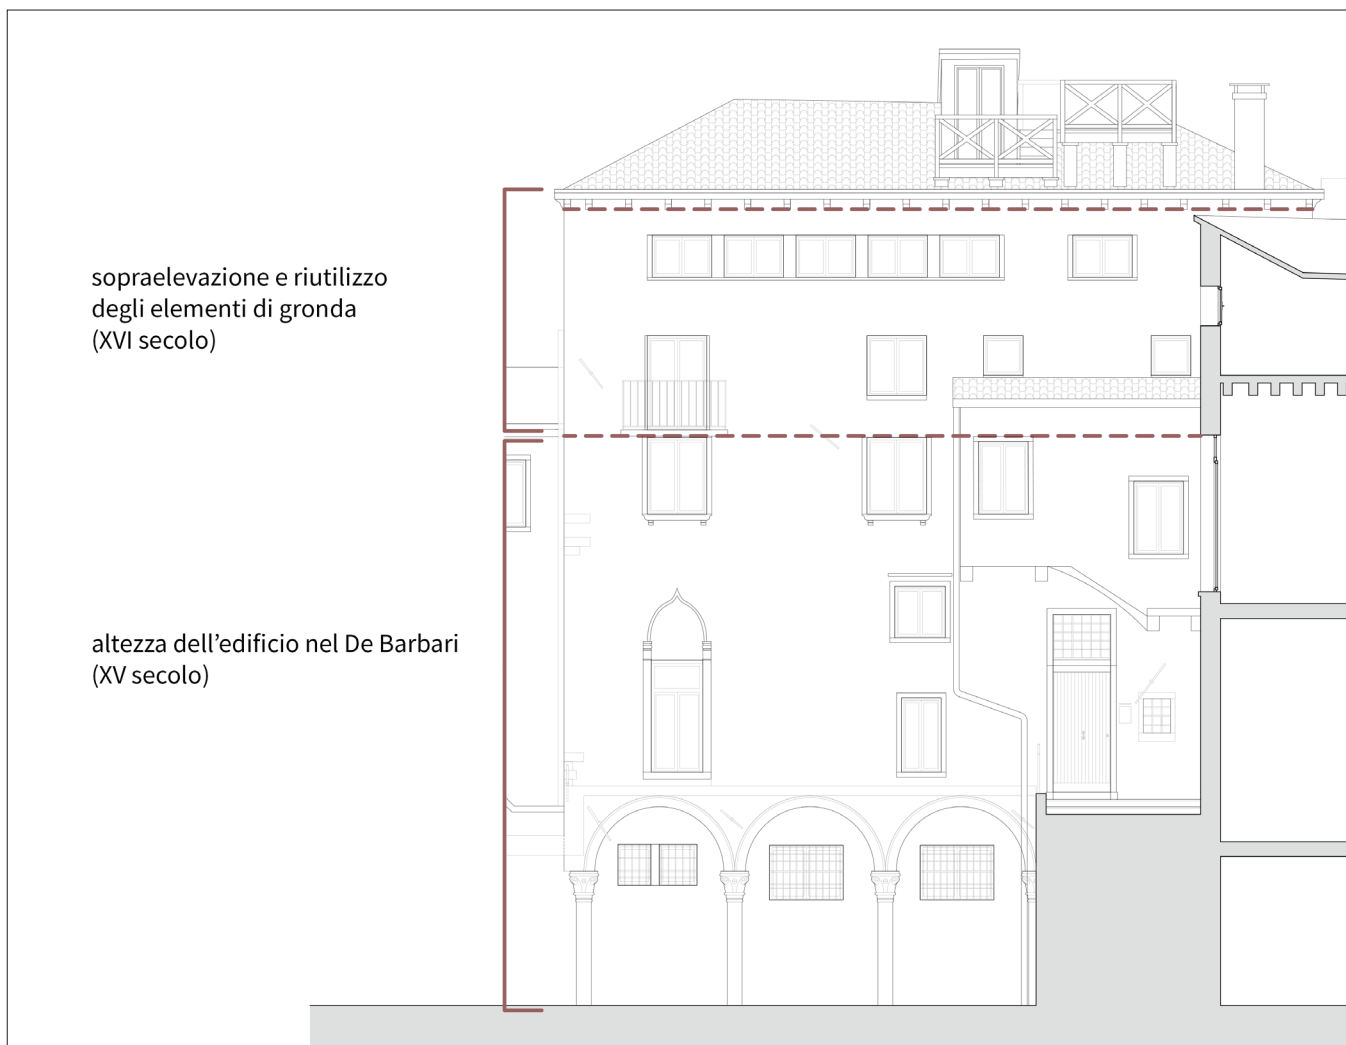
Prospetto verso la corte con indicazione della sopraelevazione storica, desunta dalla posizione di finestre e dipinti murali
